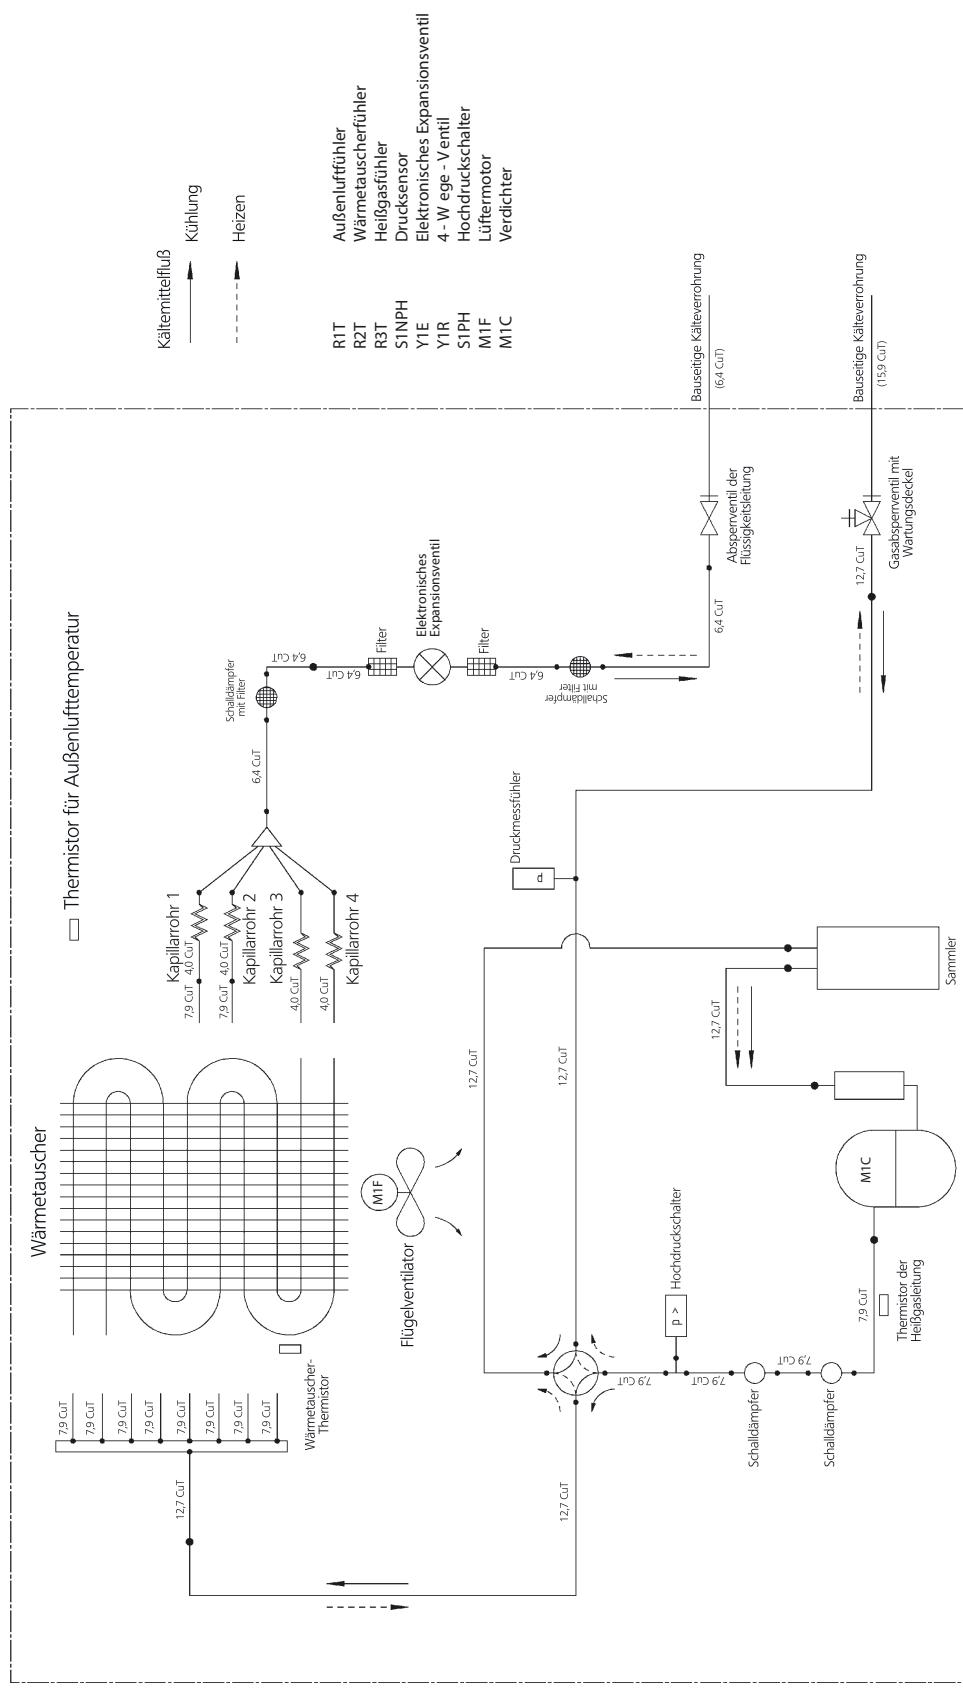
Kältetechnischer Aufbau - Außengerät RRLQ00(4/6/8)
